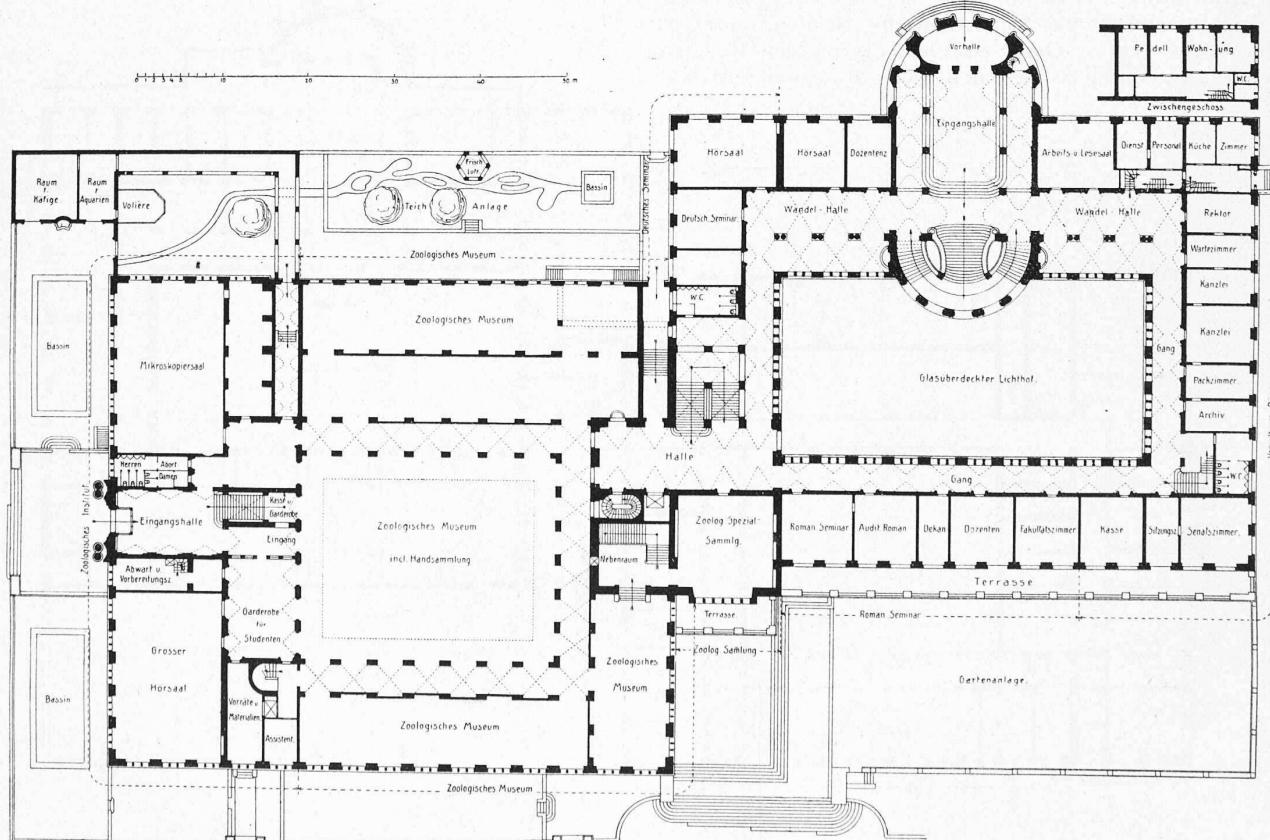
Grundriss vom Erdgeschoss. — Maßstab 1:800.
